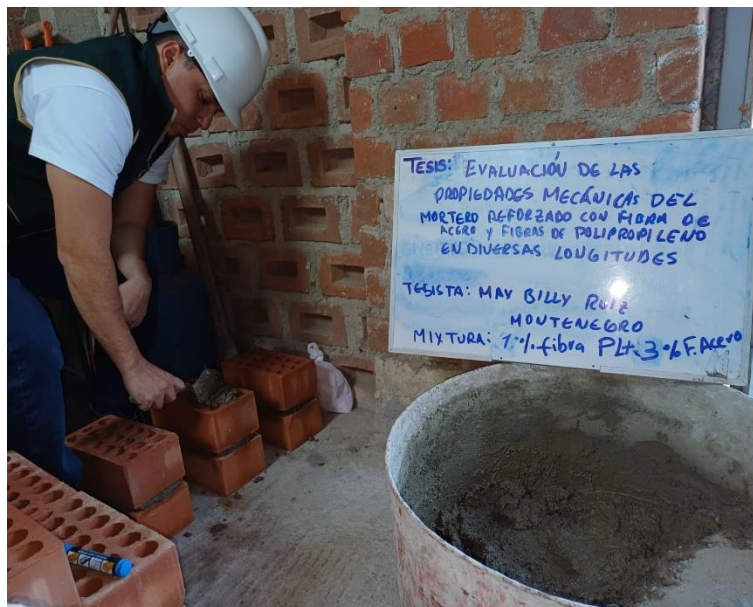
Colocación de mortero Mixtura:1%FA+2%FPP en pilas de 3 unidades
